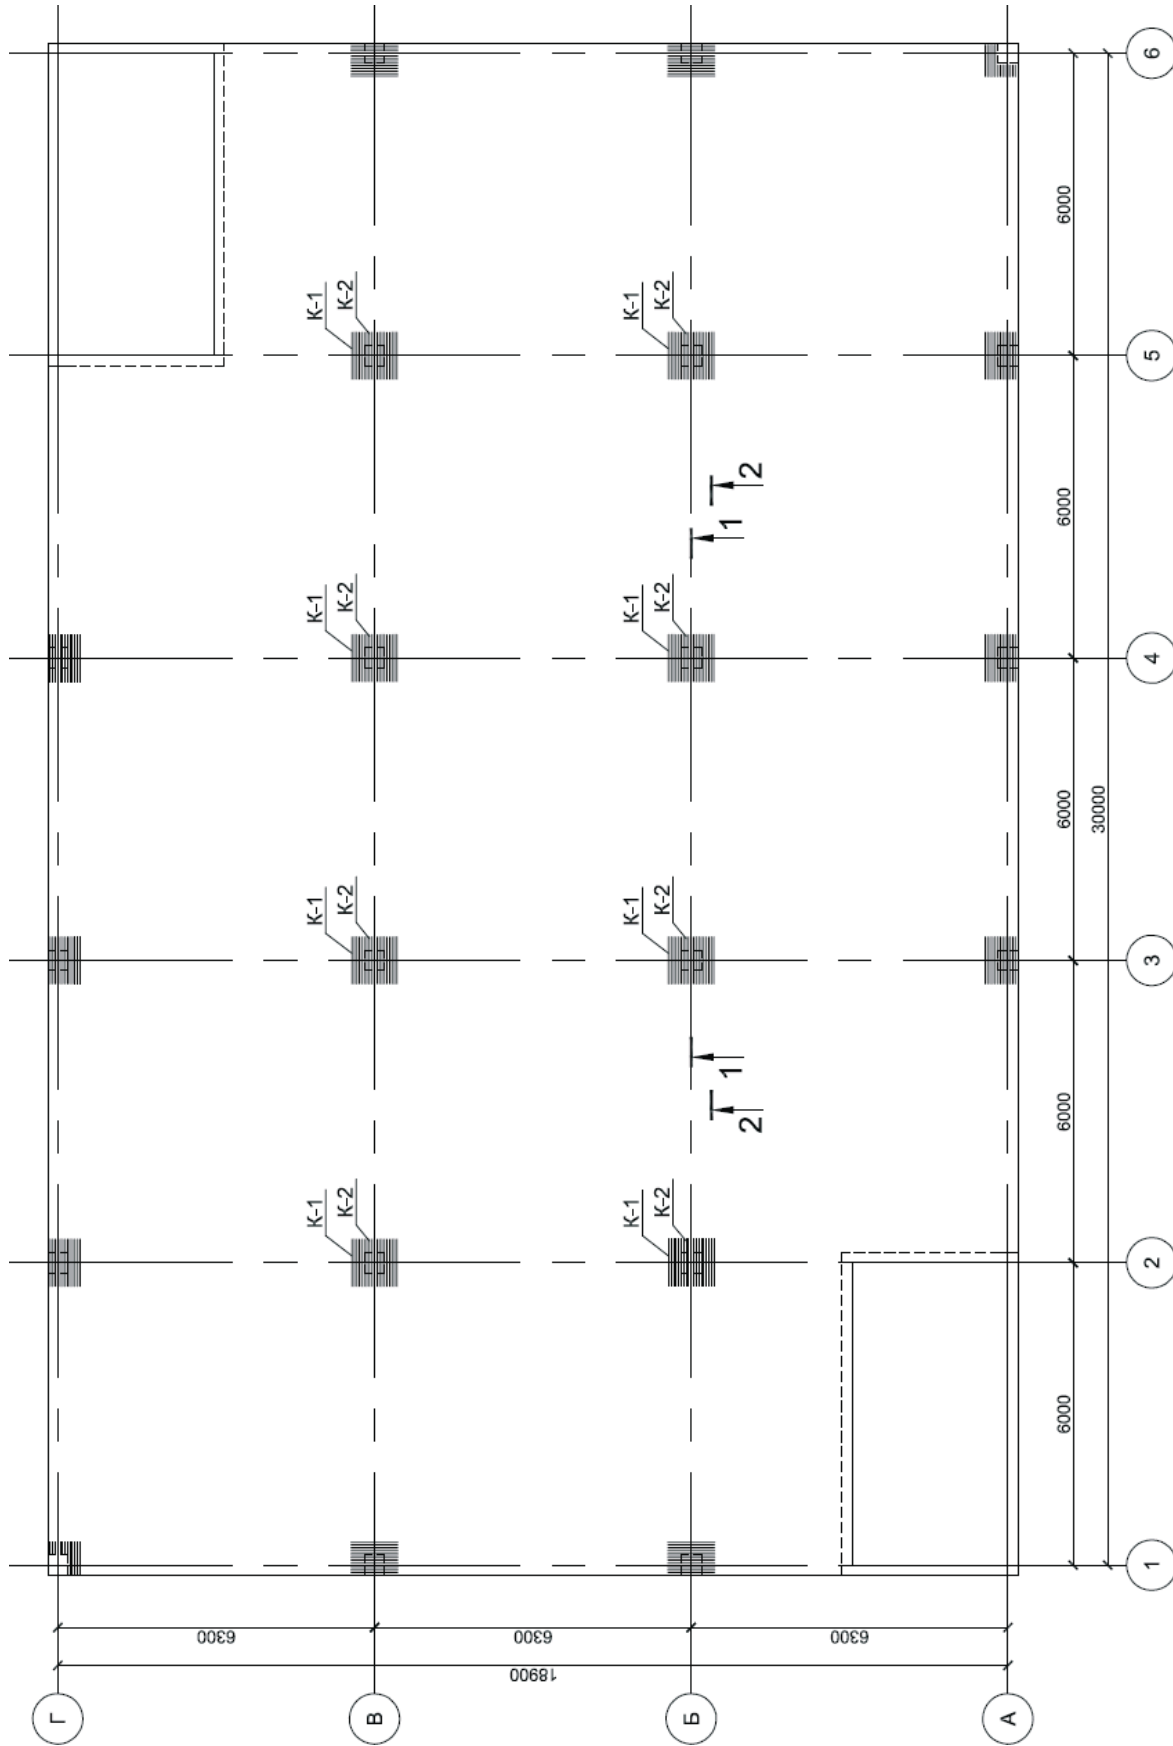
Дополнительное армирование плиты перекрытия в зонах продавливания.
